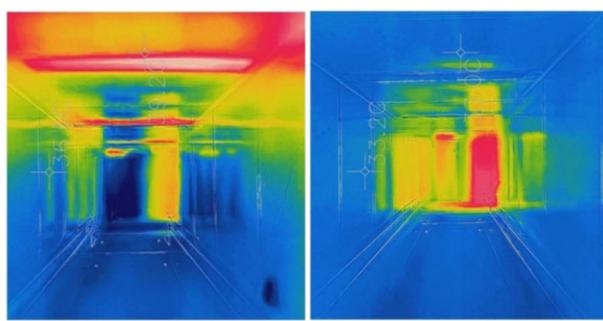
PBBへの施工前後の表面温度の比較(左:施工前、右:施工後)
